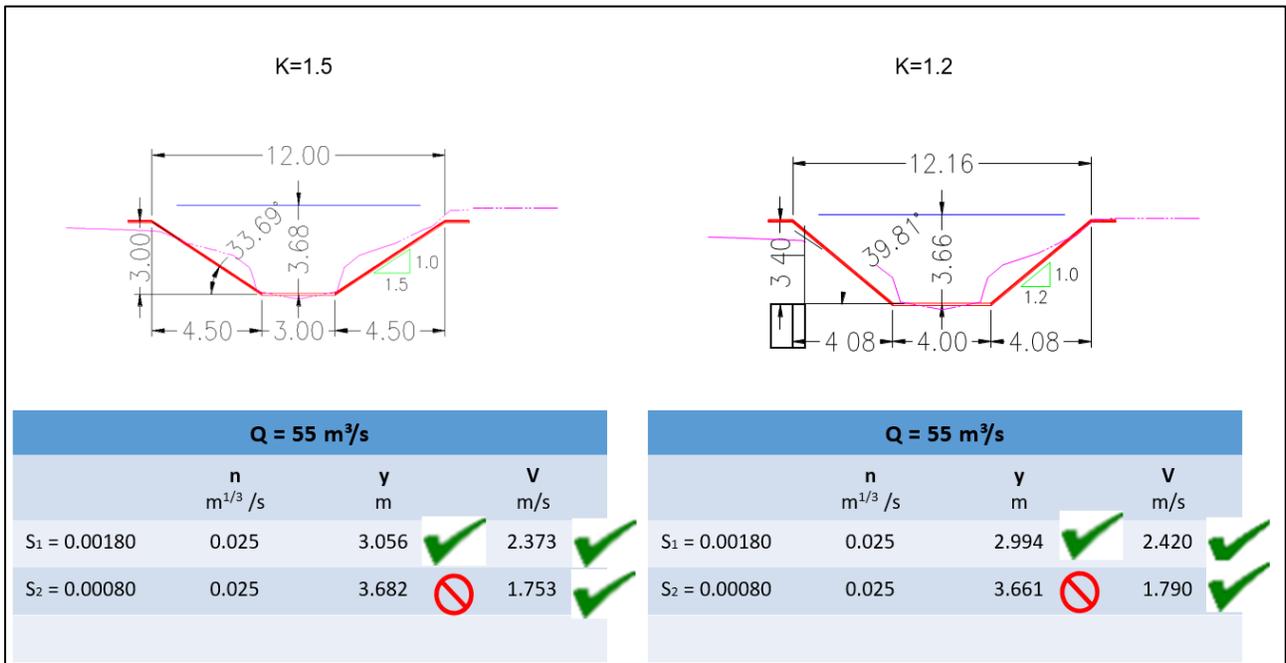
Opción 1 Sección de mampostería con fondo fijo (con plantilla de mampostería).
